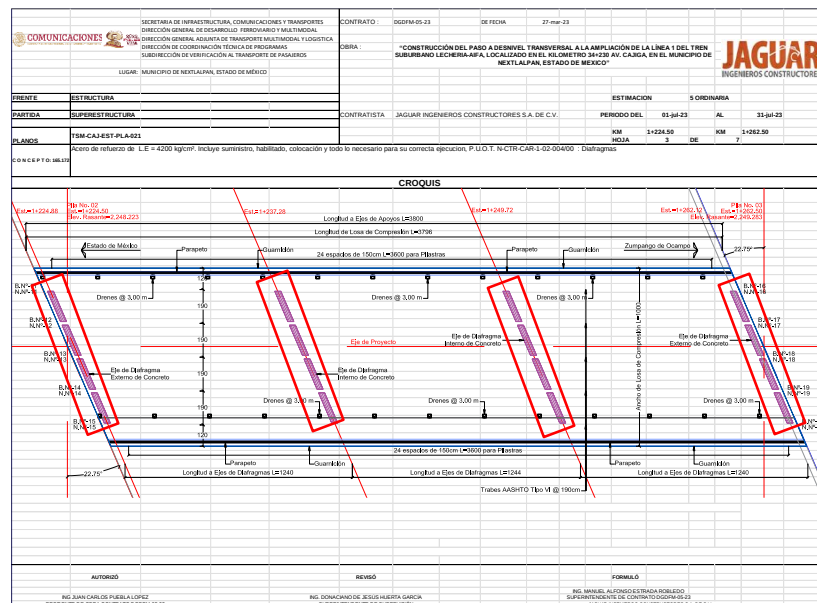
NOTA: Adaptado de Diafragma claro 02, Autoría Propia, 2023
